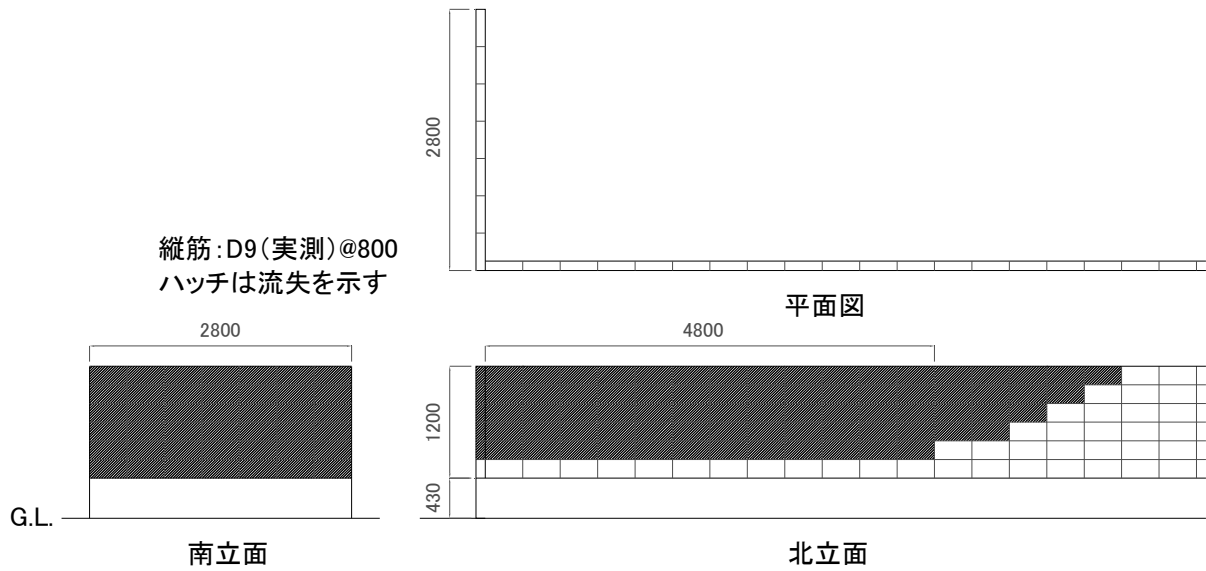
CB 塀の平面図・立面図 (単位: mm)
